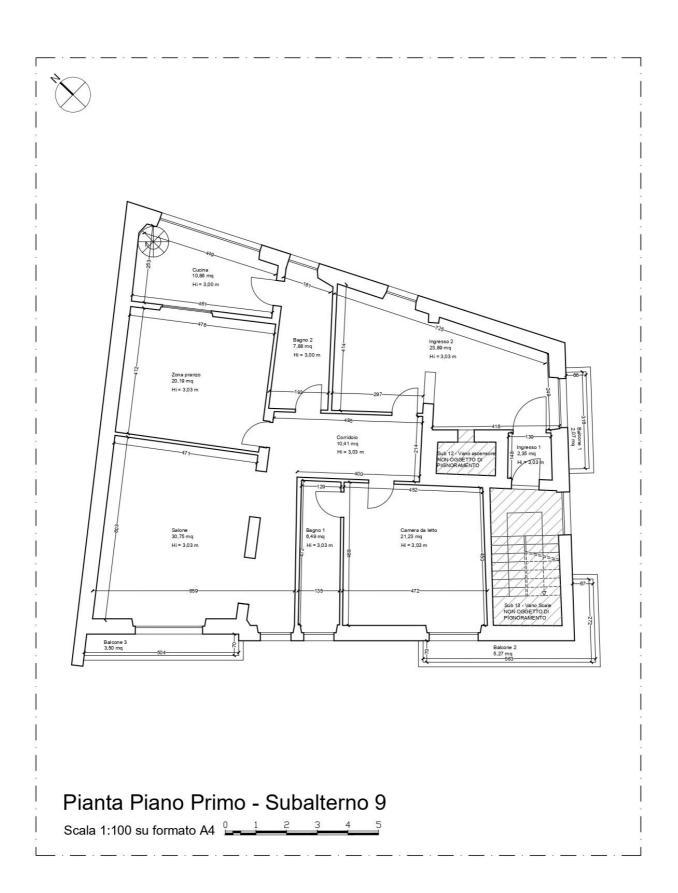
Piano Primo – Subalterno 9 Planimetria dello stato di fatto rilevato
